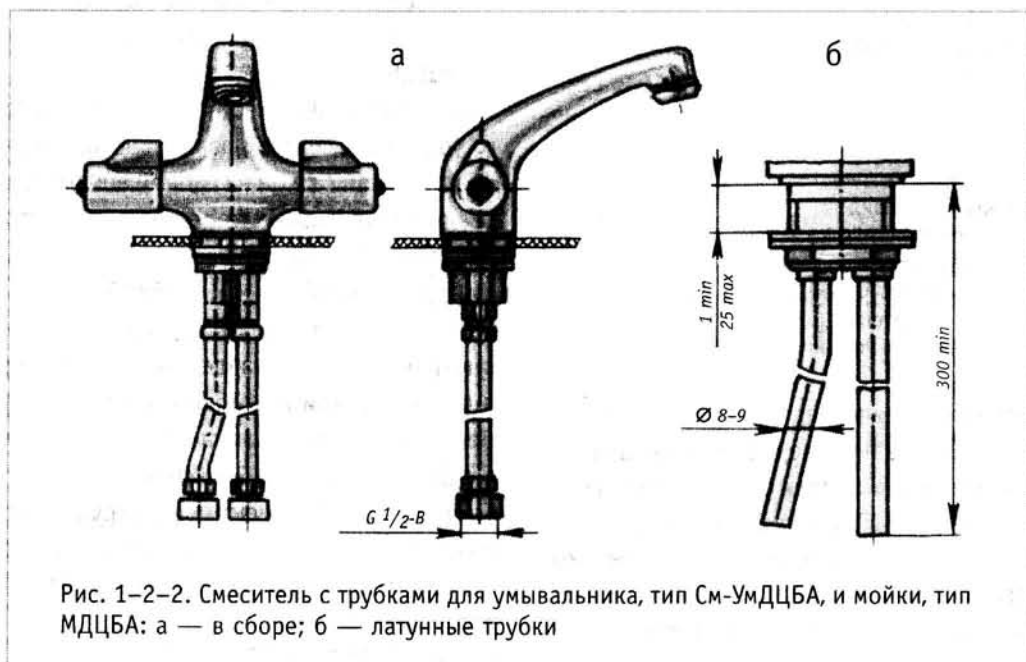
Смеситель с трубками для умывальника, тип См-УмДЦБА, и мойки, тип МДЦБА: а — в сборе; б — латунные трубки
